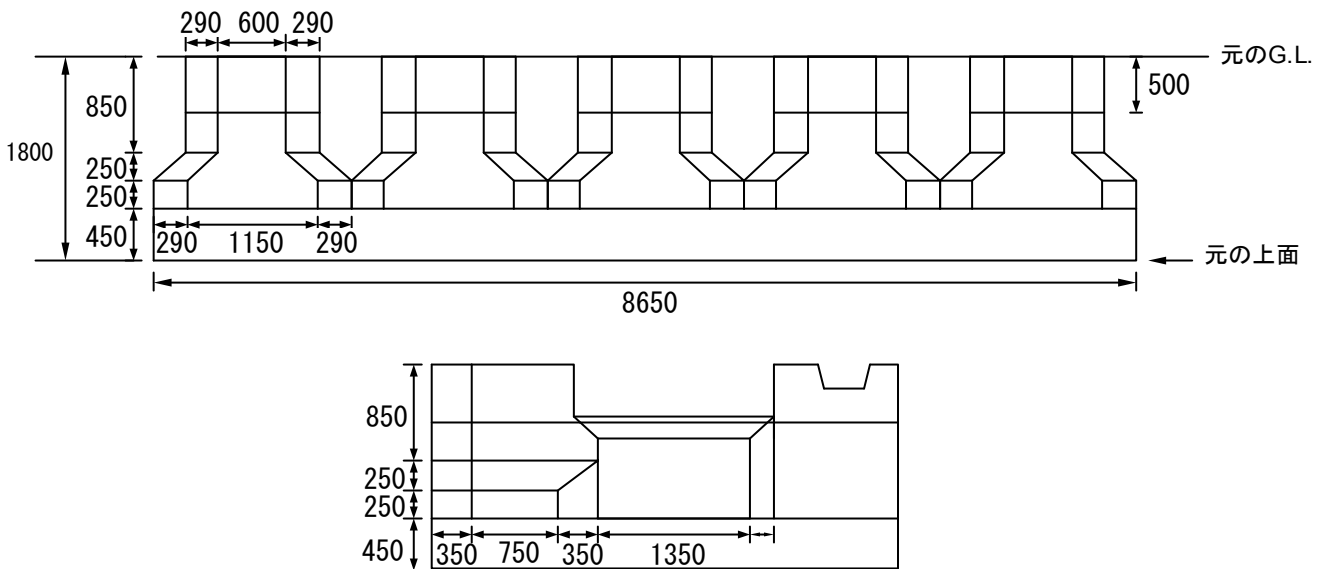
構造体立面図（単位：mm）（上下転倒した状態）
